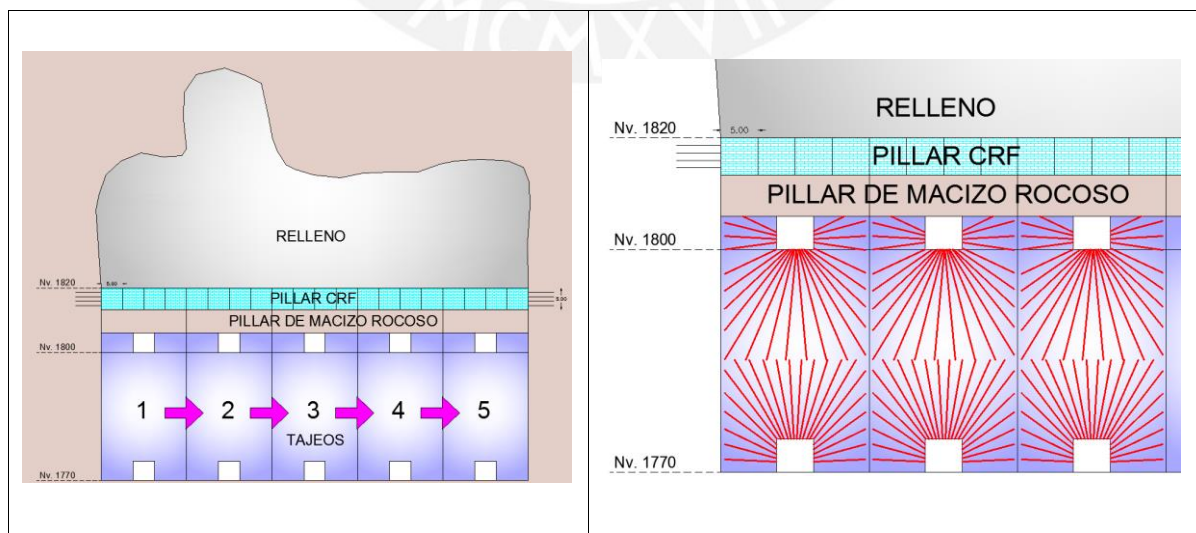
Recuperación de pilar 1770 - 1820 mediante un pilar híbrido.
